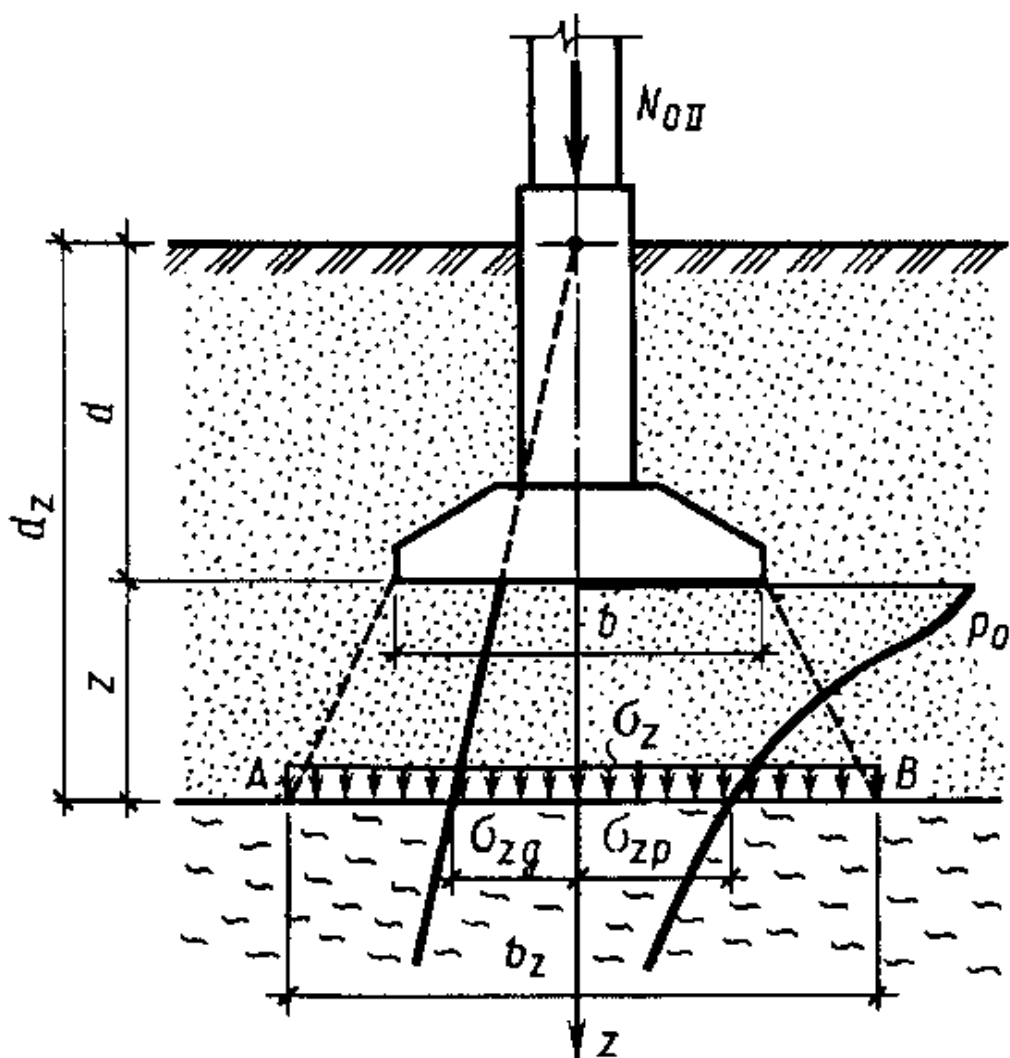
Розрахункова схема для перевірки тиску на слабопідстеляючий шар ґрунту основи
